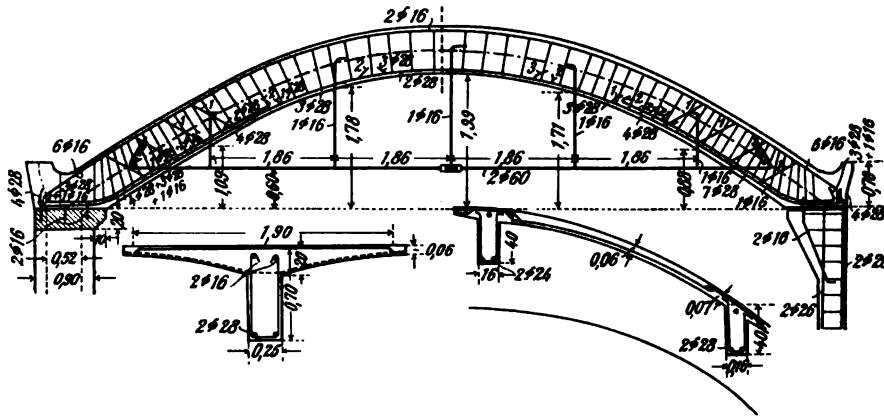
bis 277. Ansicht der Bogenbinder mit Eiseneinlagen. Querschnitt der Binder und Pfetten.
